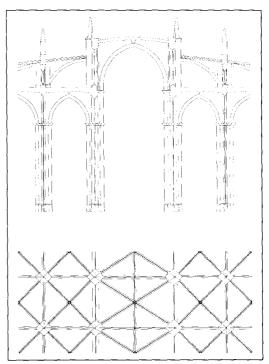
Sección transversal y planta (parciales) de la Catedral de Sevilla
